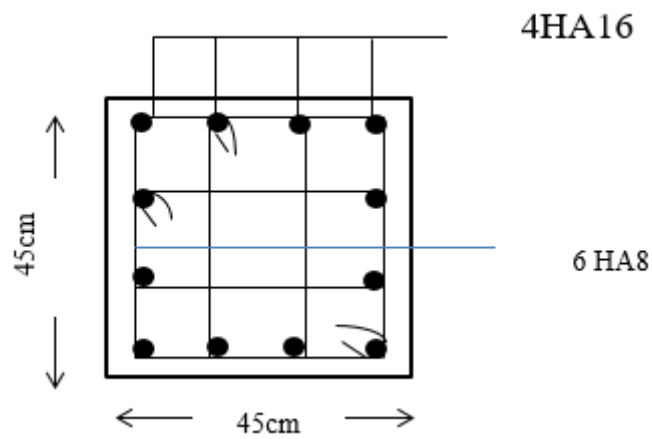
Schéma de ferrailage des poteaux du 2^{ème} étage.
